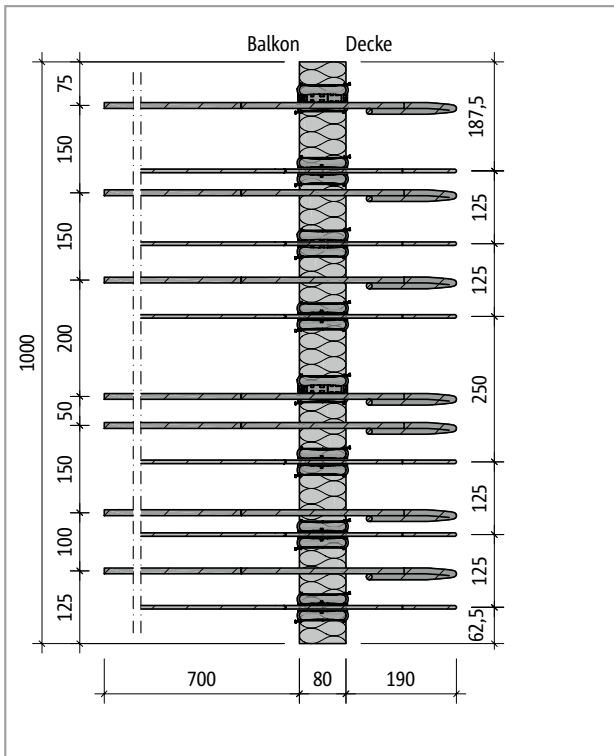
Schöck Isokorb® T Typ K-WO-M2: Produktgrundriss
